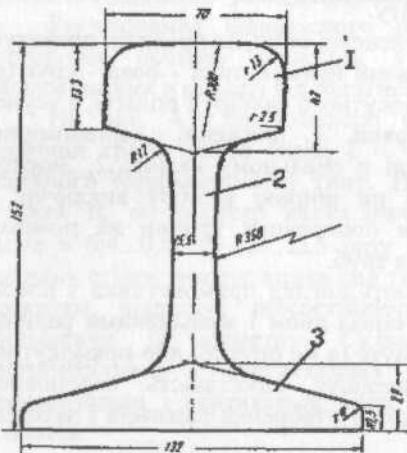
Профіль рейки Р-50: 1 - головка; 2 - шийка; 3 - підошва.
